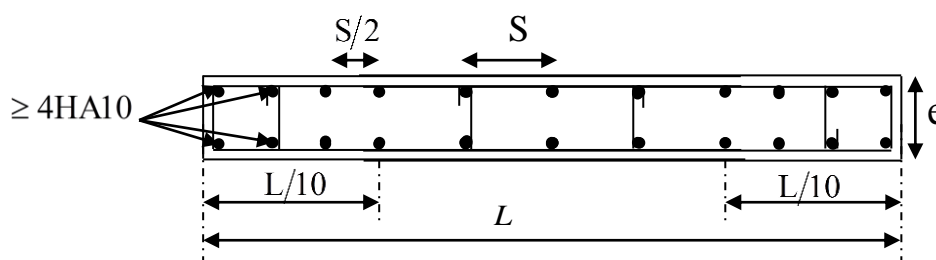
Disposition des armatures verticales dans les voiles.
